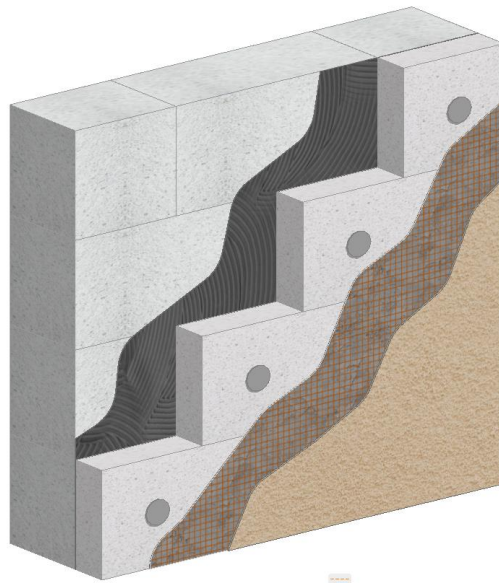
Пошарова конструкція газобетонної стіни
